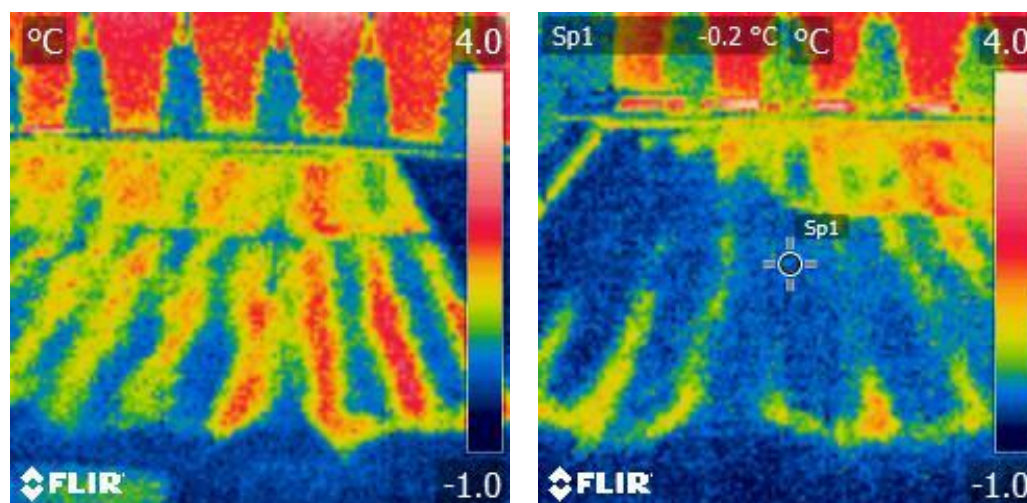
東面路面温度状況②(敷設ピッチ 300 mm 融雪パターン②)
